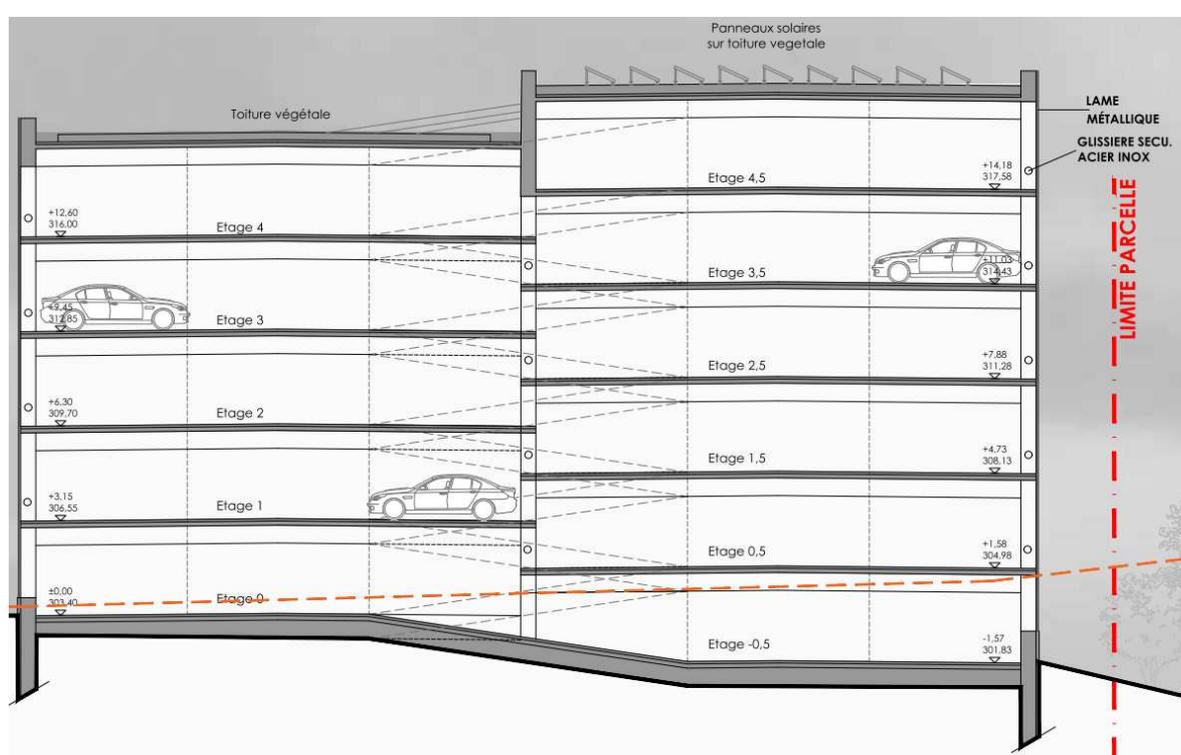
Coupe du parking projeté en stade APS (BENG).
